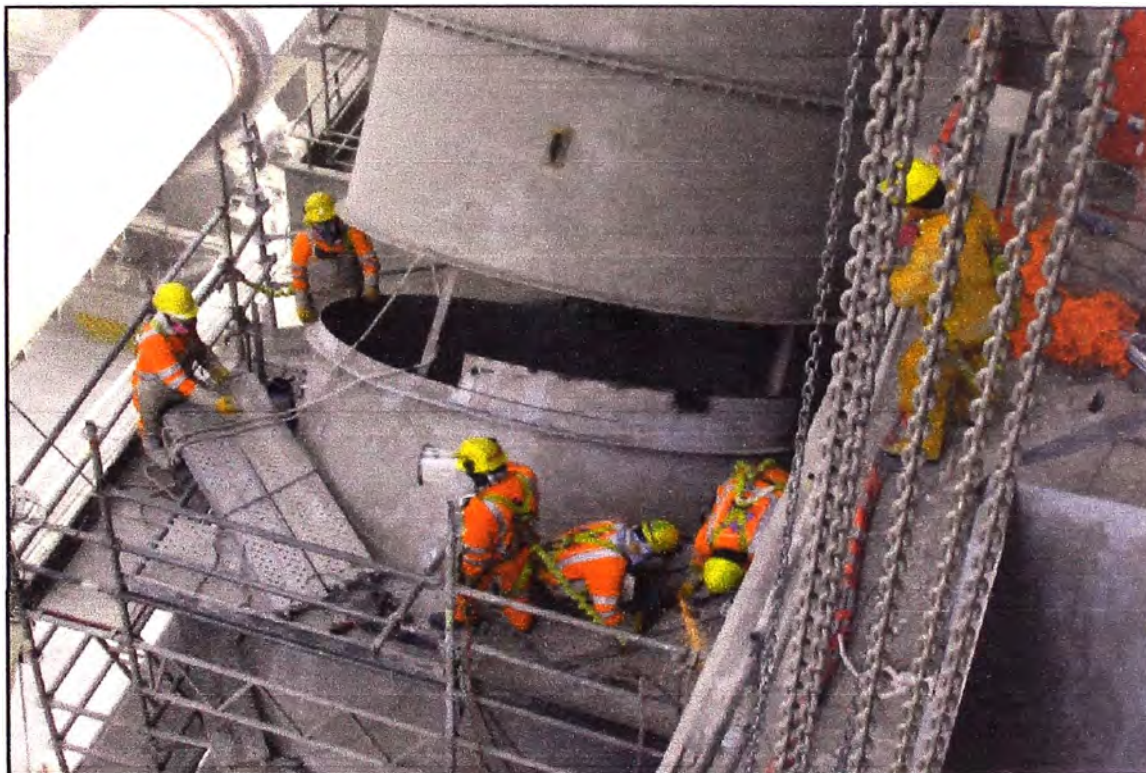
Corte de demasía en Pieza N°2 para colocación de junta de expansión 421EJ4
